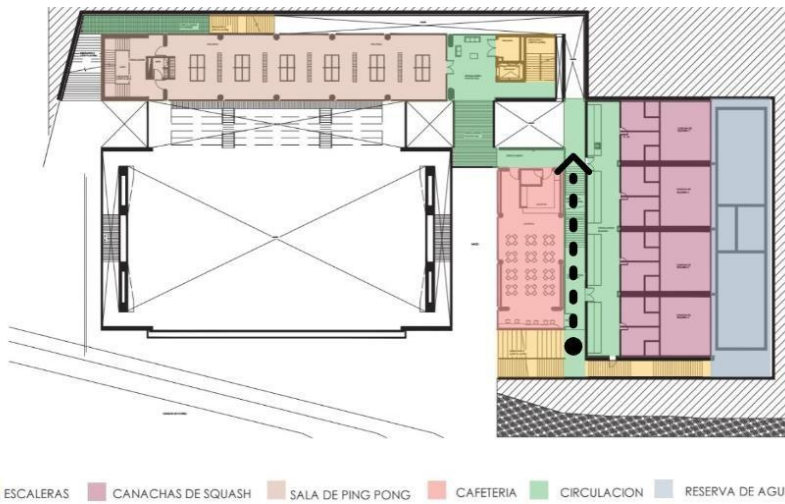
Primera planta. Centro deportivo Univ. De los Andes
